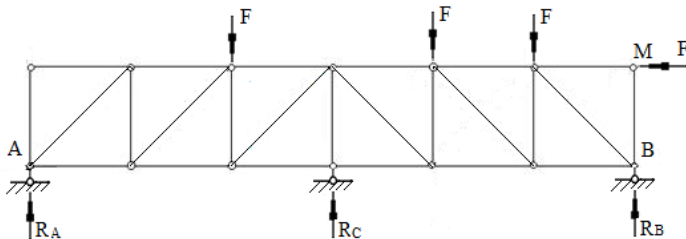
Схема простейшей фермы с подвижной опорой посередине пролета
